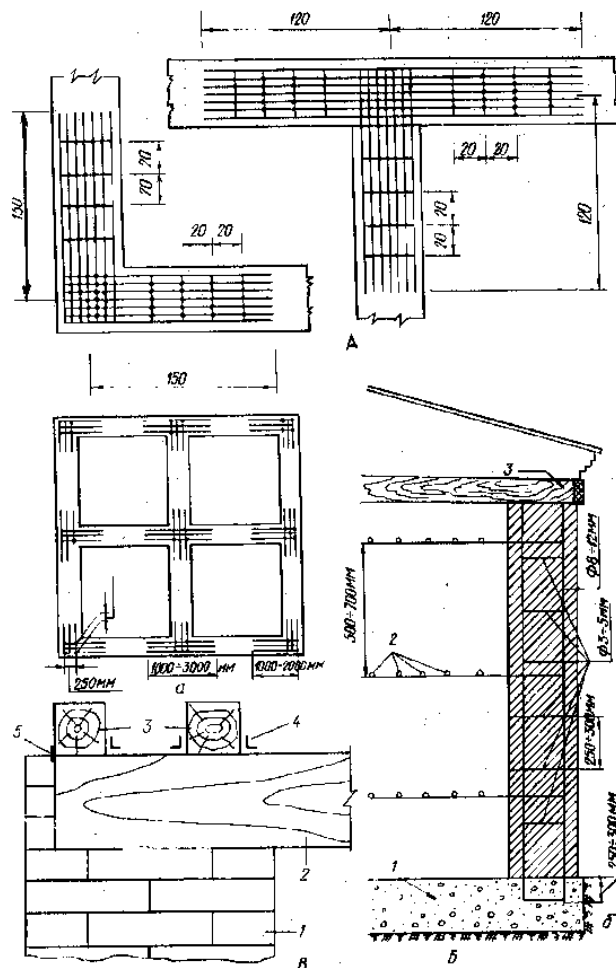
Армирование стен: А – усиление стен в угловом соединении и в сопряжениях стен; Б – схема армирования кирпичных стен: а - схематический вид в плане на армирование; б - поперечный вид армированных кирпичных стен: 1-фундамент; 2-арматурный каркас; 3-балка; В – установка прогонов и опор на фундамент: 1-фундамент; 2-прогон; 3-нижний каркас (синч); 4-уголок; 5-металлическая планка
